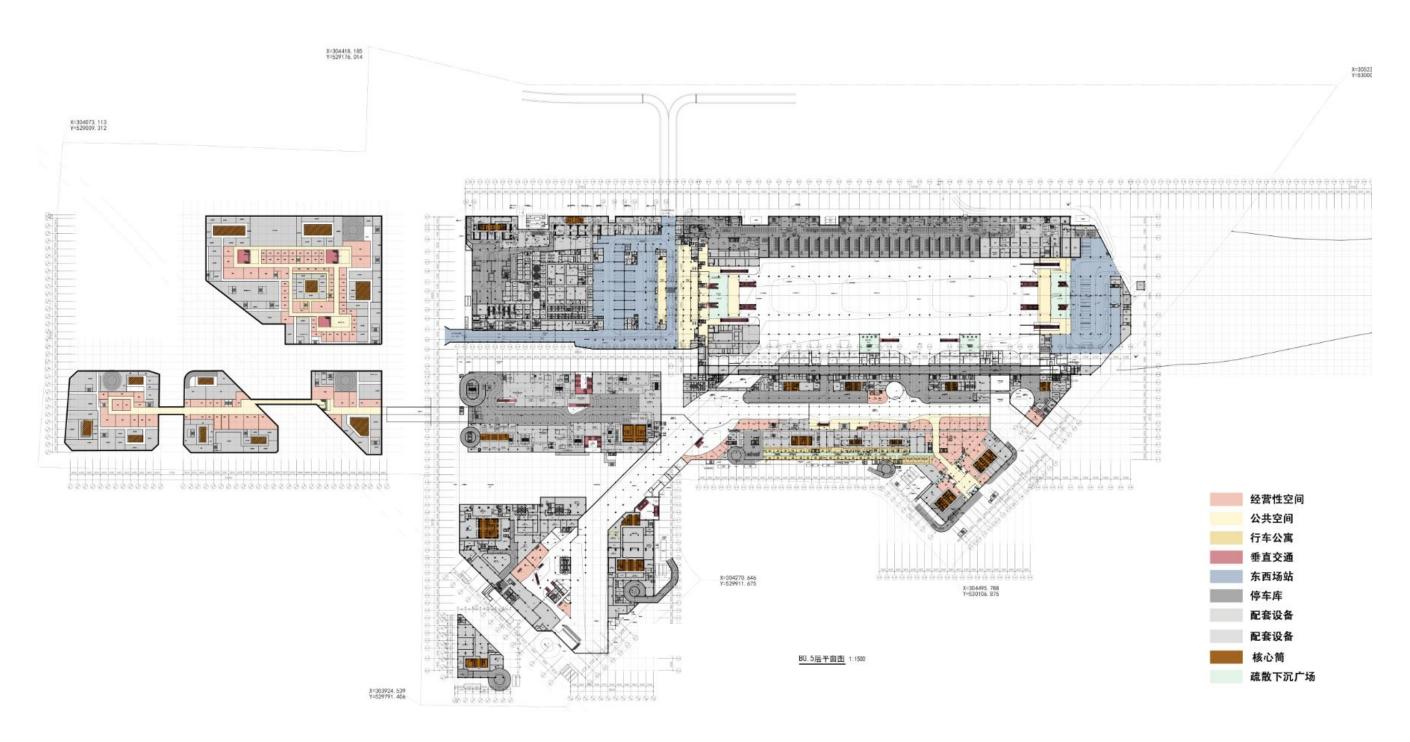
项目地下一层夹层(B0.5 层)平面图
